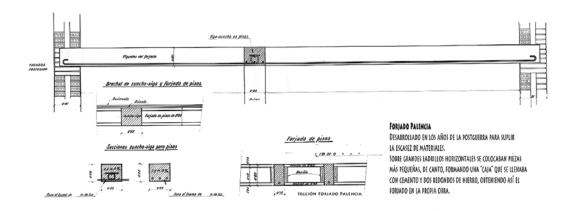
Forjado Palencia, todavía vigente en la década de los 50, Fondo Font de Bedoya, Archv^o H.P.Palencia
